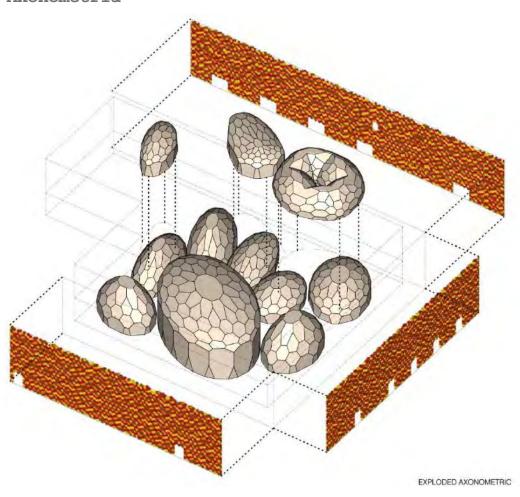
Axonometría Explotada. Muestra las tres fachadas del pabellón y los domos interiores. (AZPML)
